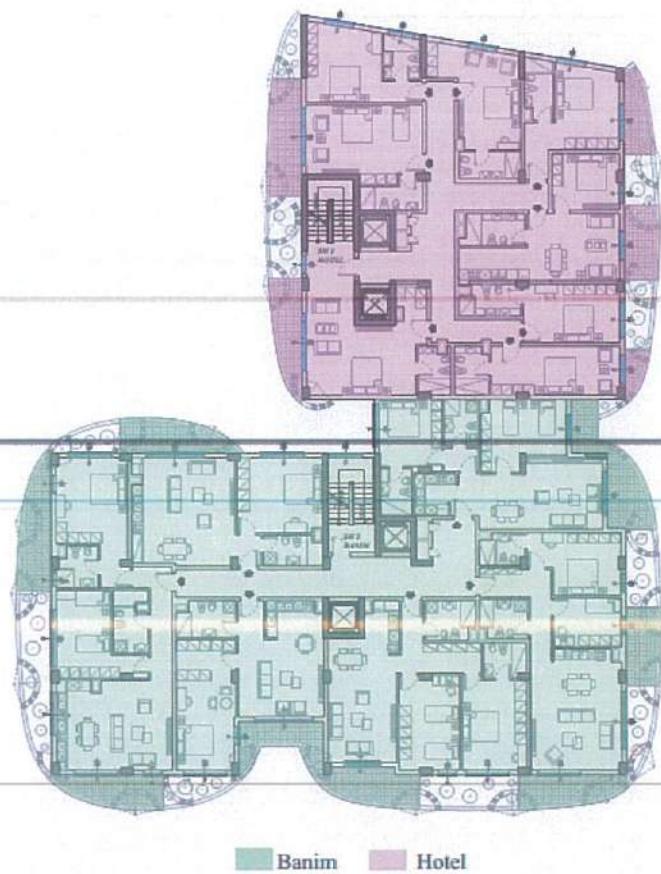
Ndarja e funksioneve brenda planimetrisë së katit tip
